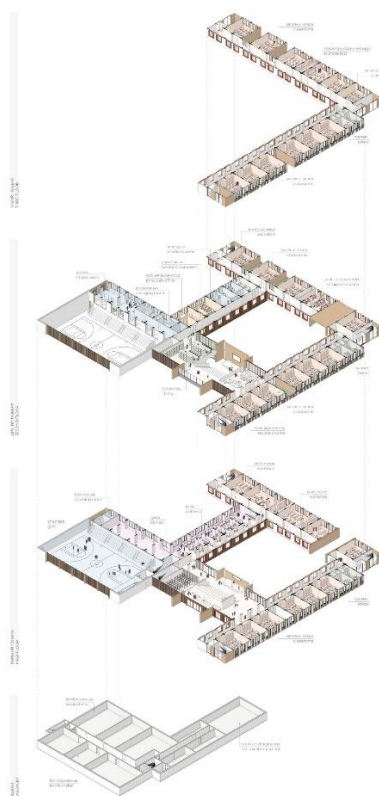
Ізометрична схема будівлі, розділена по поверхам [27]
